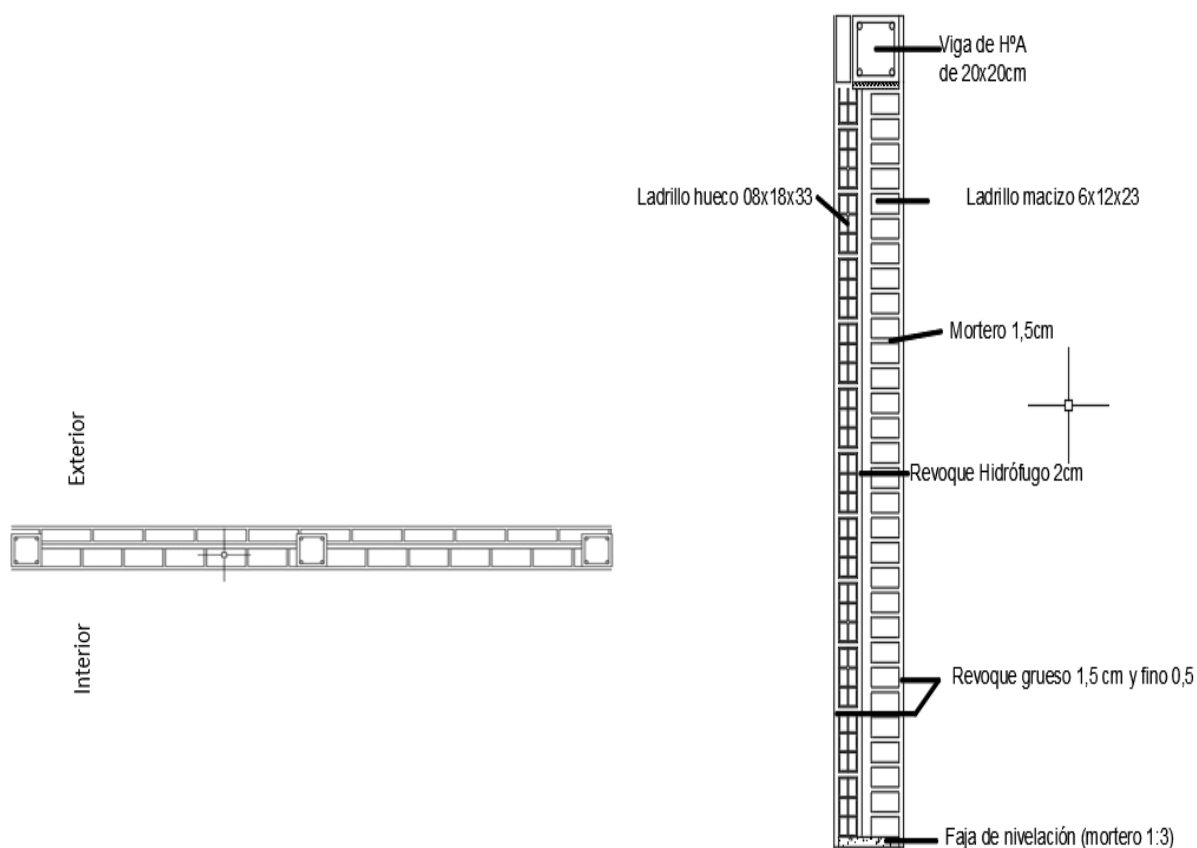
y 13– Planta y corte vertical del muro Tipo E, doble muro de construcción húmeda.
